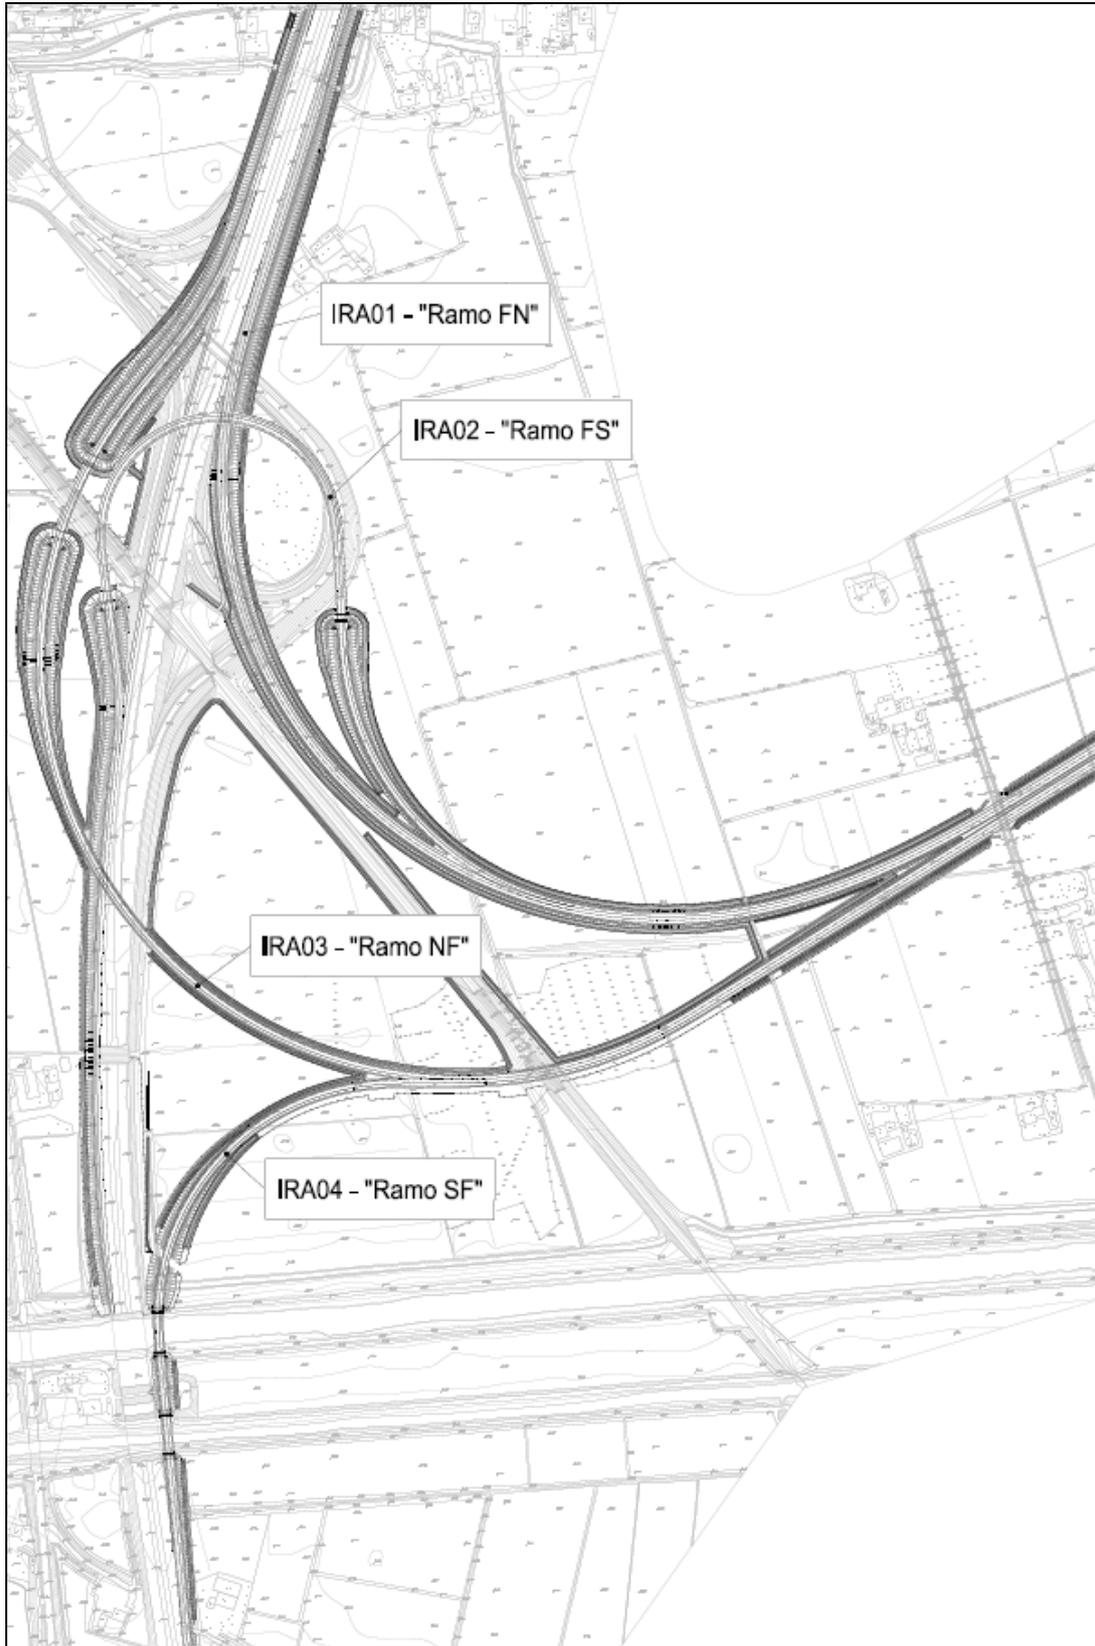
SCHEMA PLANIMETRICO INTERCONNESSIONE CON A22
